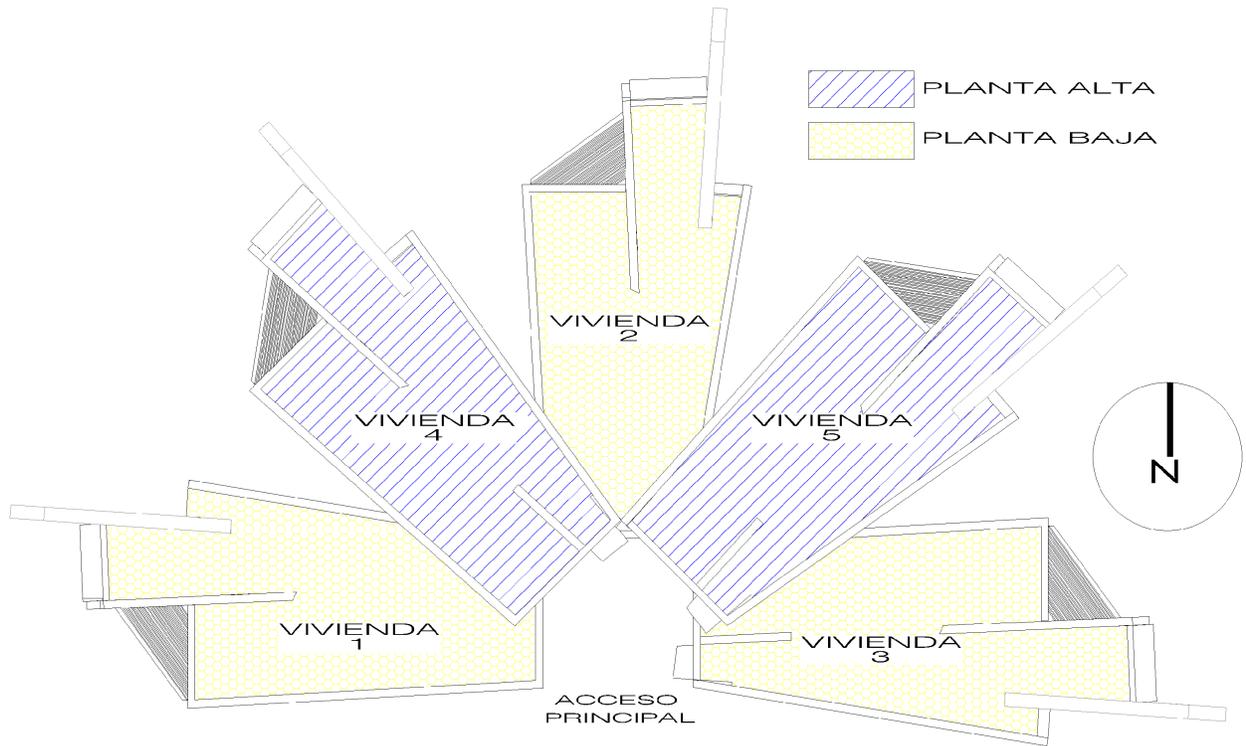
Esquema en planta de conjunto con las cinco viviendas tipo.
